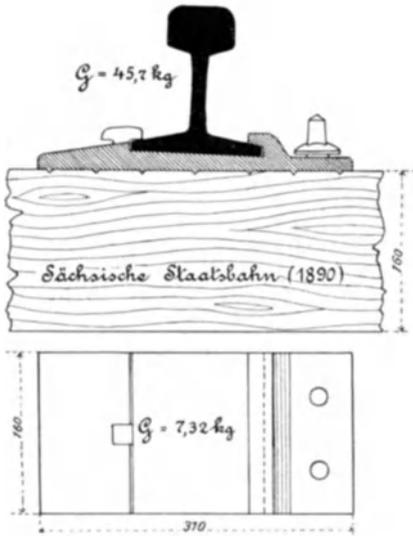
Schwerer sächsischer Oberbau auf Holzschwellen.
